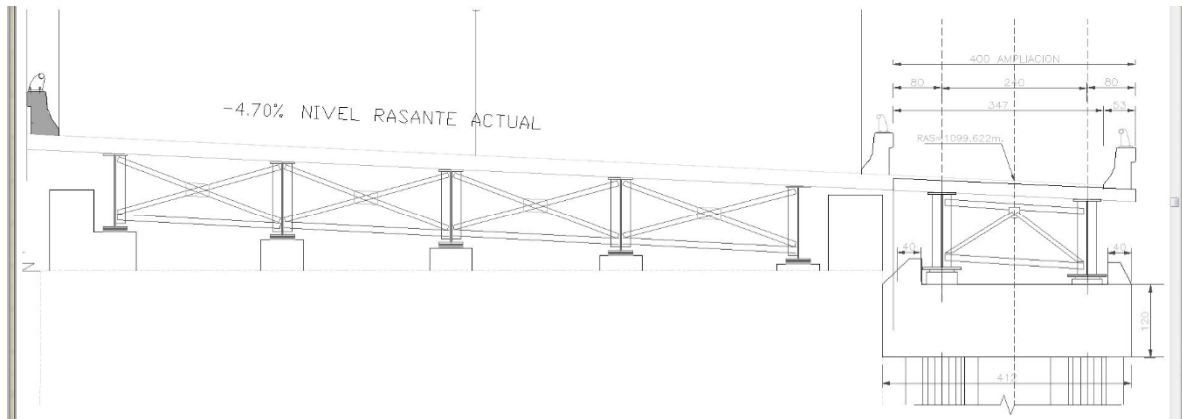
Sección transversal caballetes Puente Multitajo.
